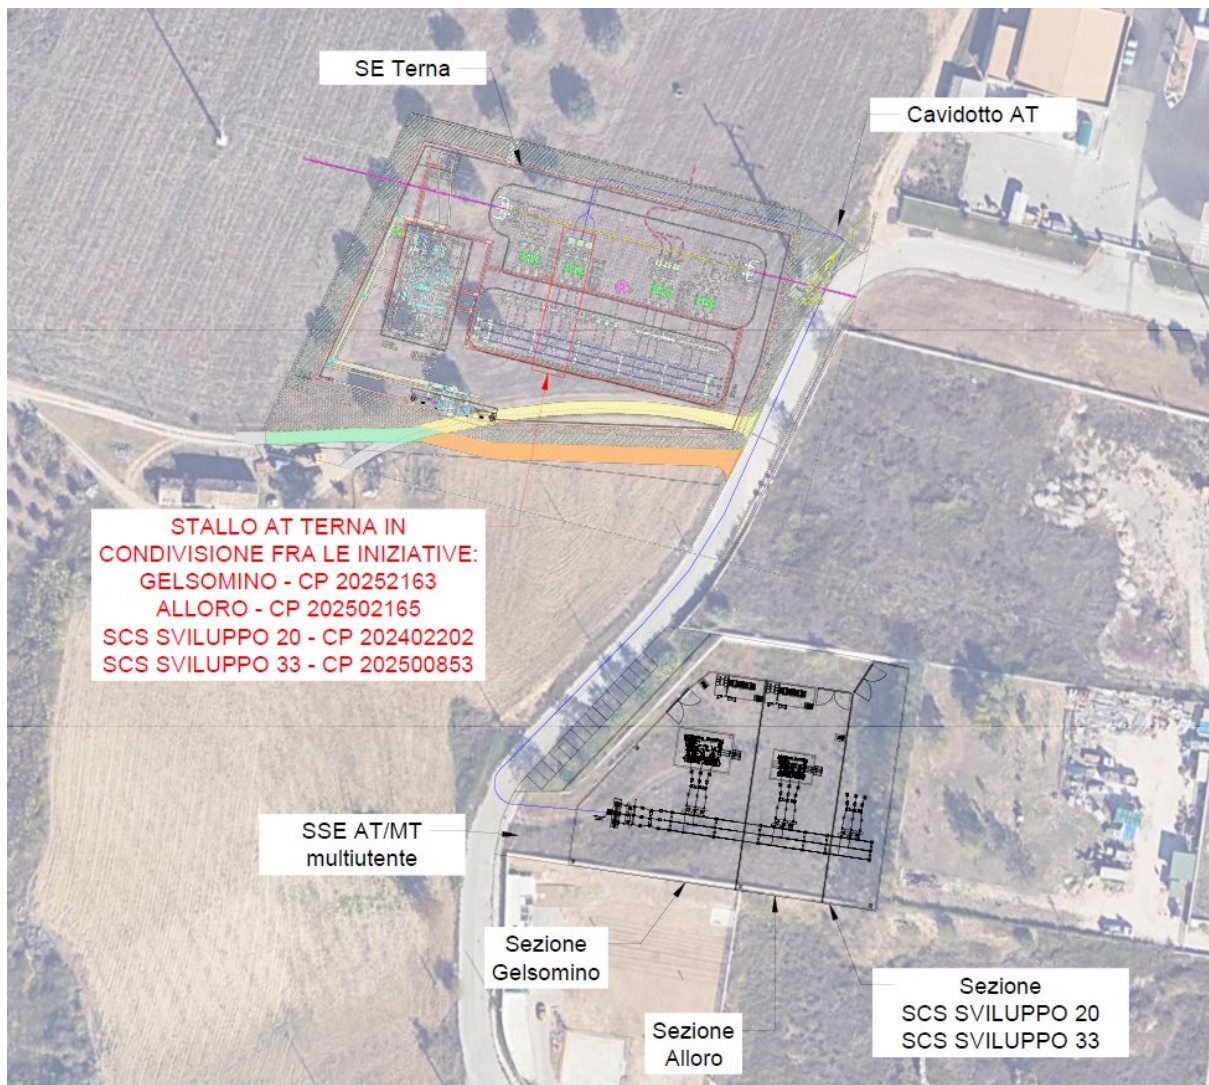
Connessione alla RTN - Inquadramento planimetria generale su ortofoto
